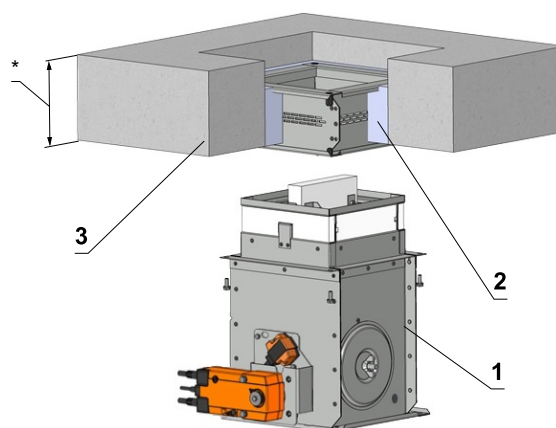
Massive Deckenkonstruktion - Einbaurahmen E1, E2, E4
